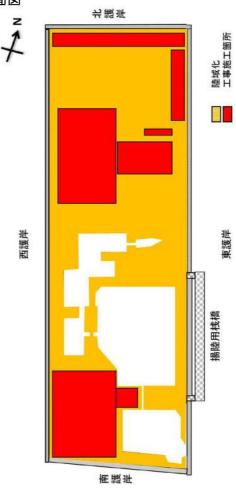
廃棄物埋立場所(神戸沖埋立処分場)の平面図
